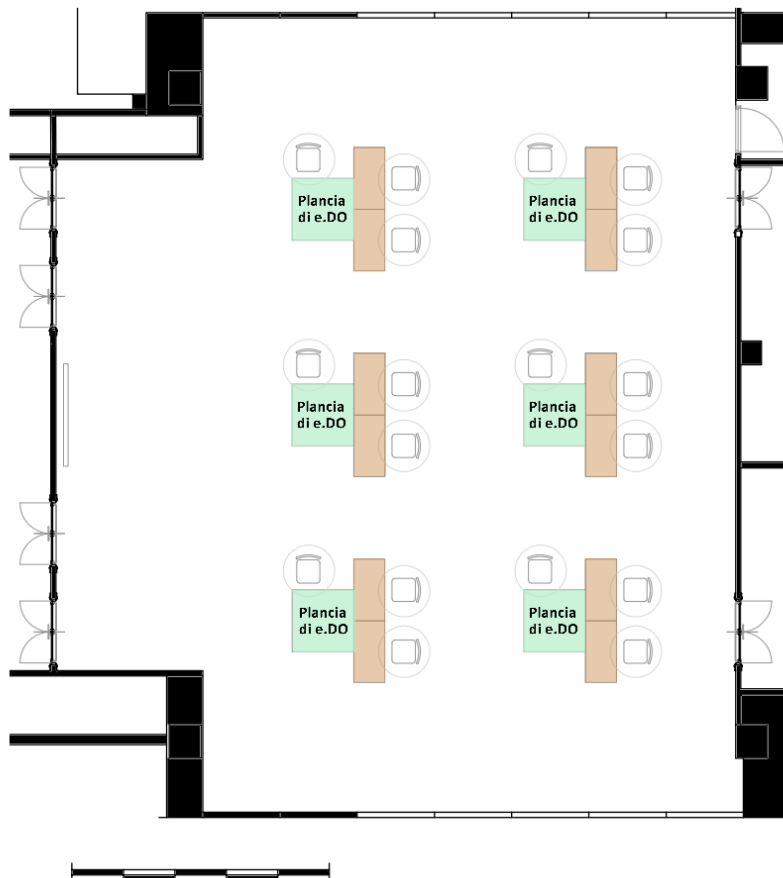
Planimetria del Setting d'aula di "COMBO" Restart presso l'Auditorium di Fondazione Agnelli
